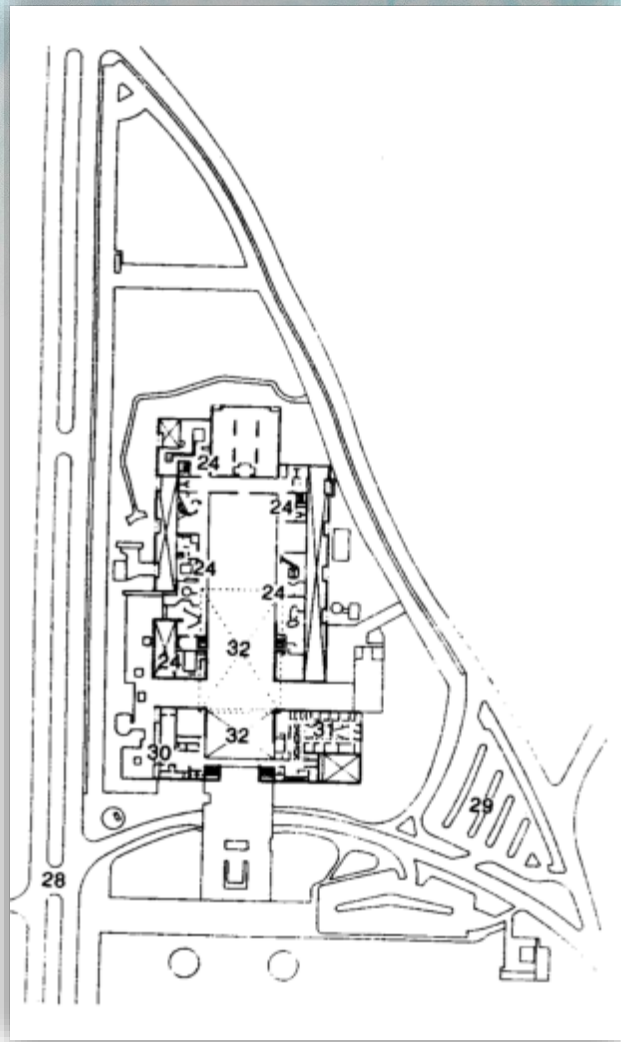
Museo Nacional de Antropología. Plantas Arquitectónicas
